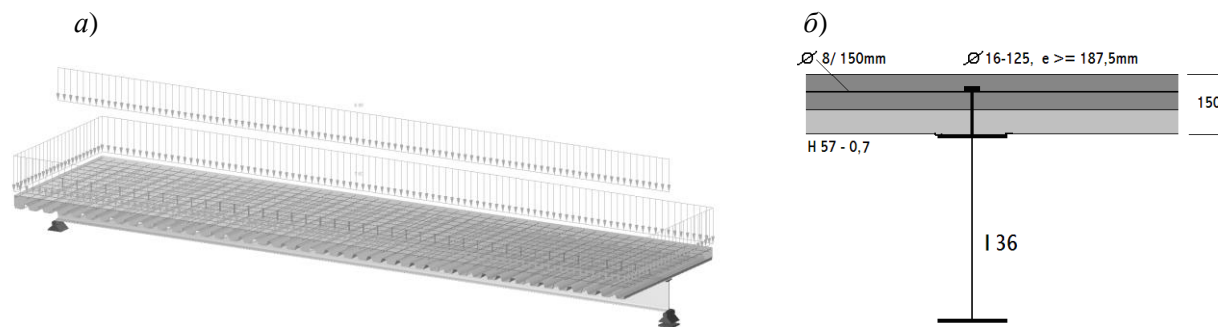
Розрахункова модель (а) та поперечний переріз сталезалізобетонної балки комбінованого перерізу (б)
